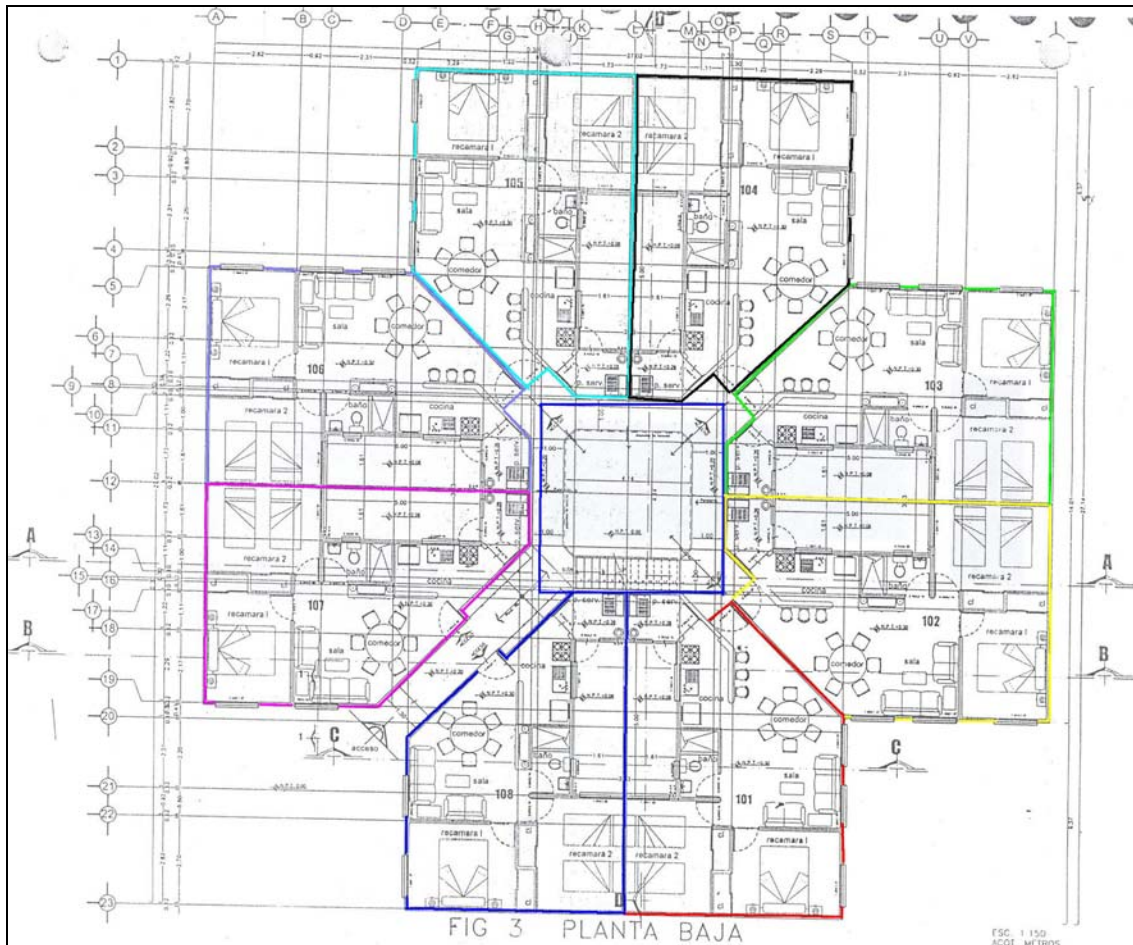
Planta baja tipo Edificio Arcos de Aragón
